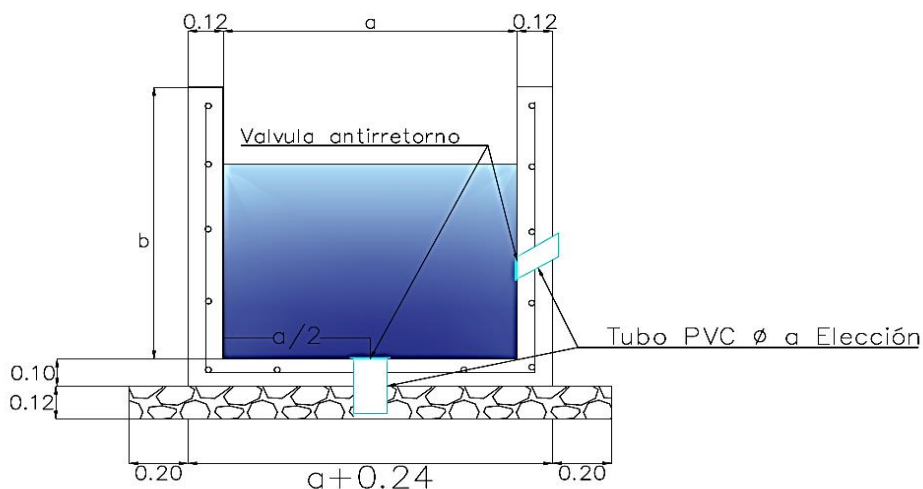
Sección tipo drenaje de barbacanas en losa y en muro (cotas en m).
